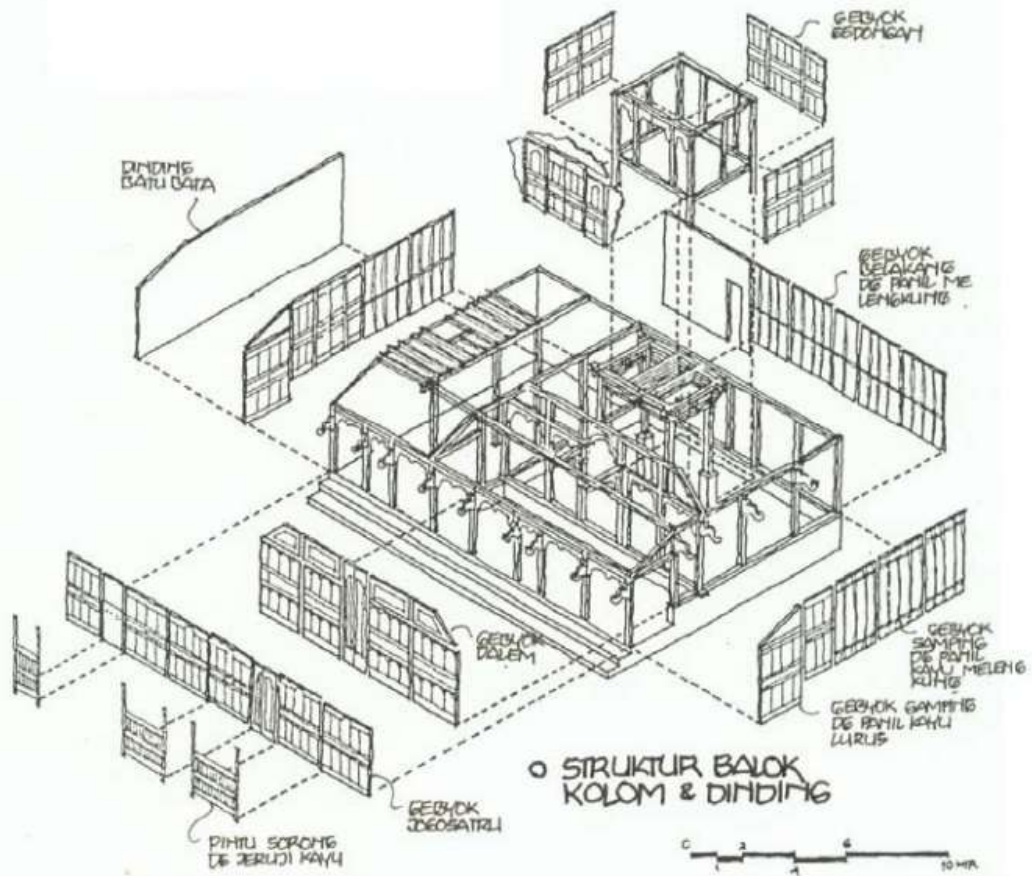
Sketsa Sistem Struktur Konstruksi Bangunan 1 dan 2 lantai, terlihat rangka struktur bangunan berupa sloof, kolom, balok, kuda-kuda (Sumber : sketsa penulis)
